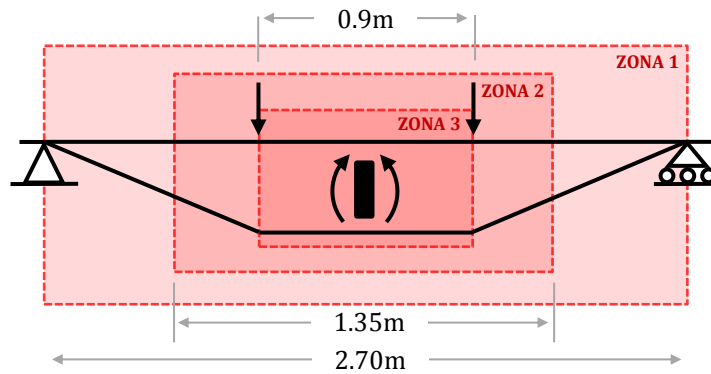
Área de estudio de la separación entre fisuras
